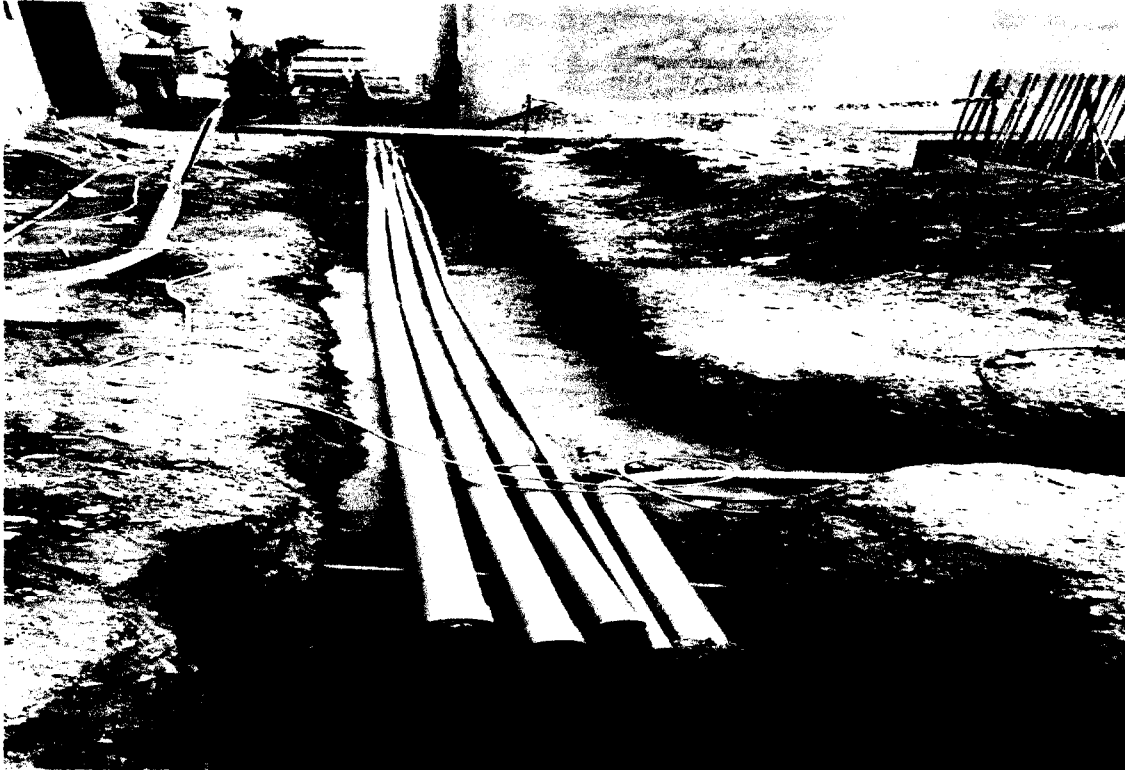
Tubería de PVC eléctrico de 25 mm en redes
